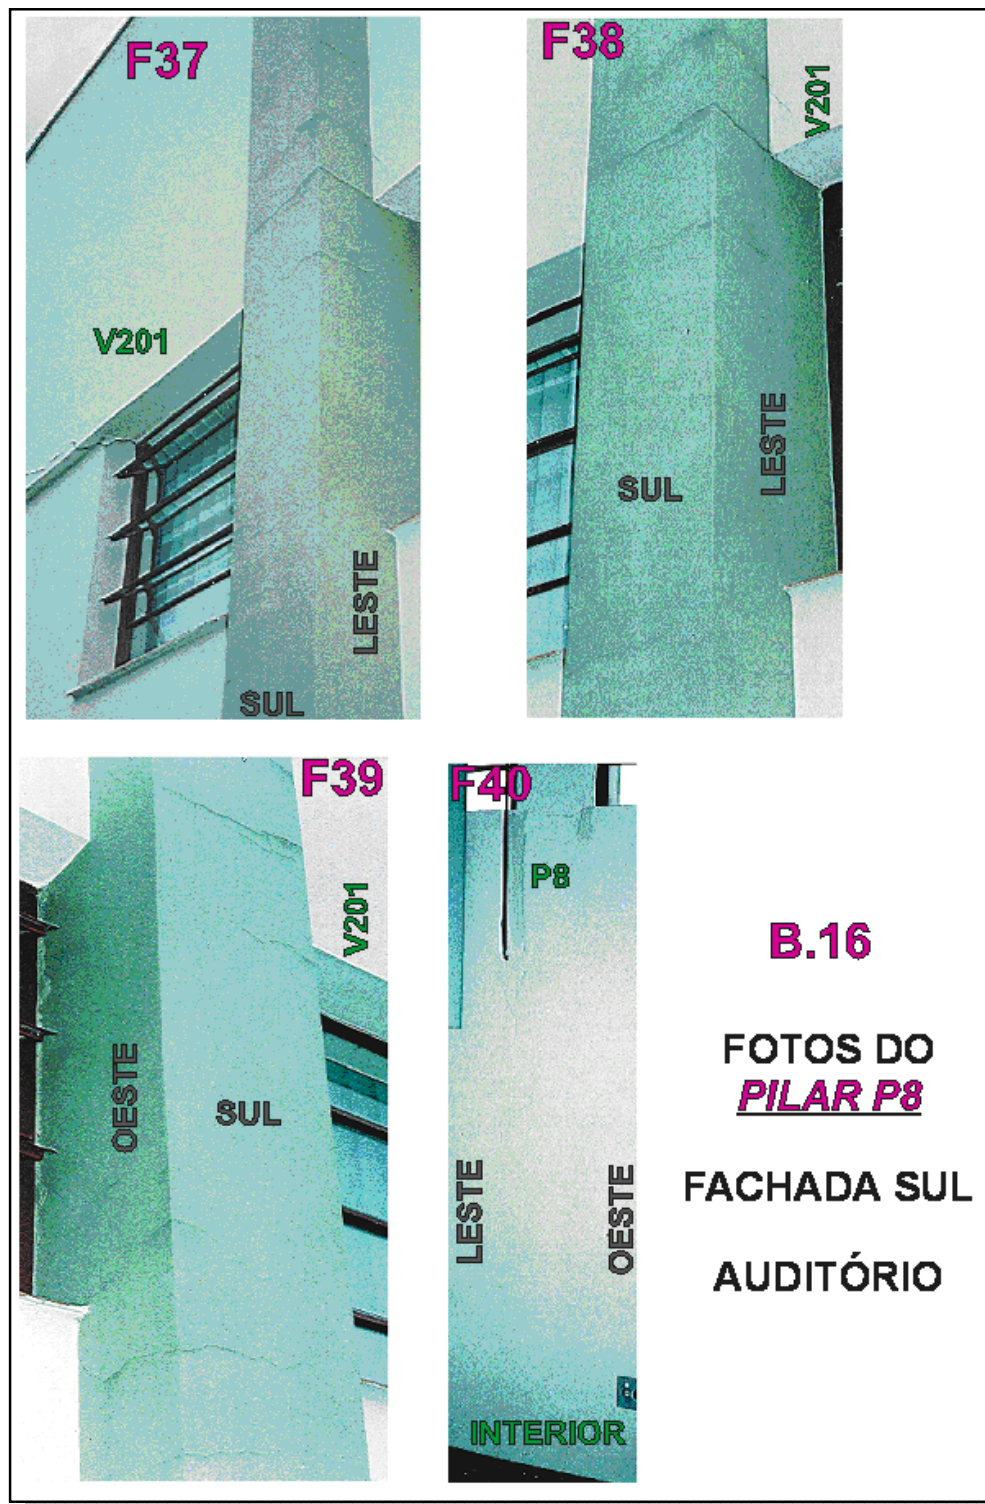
Fotos de fissuras manifestando-se no pilar P8, fachada sul do auditório (ISAIA, 2001, p. 59)
